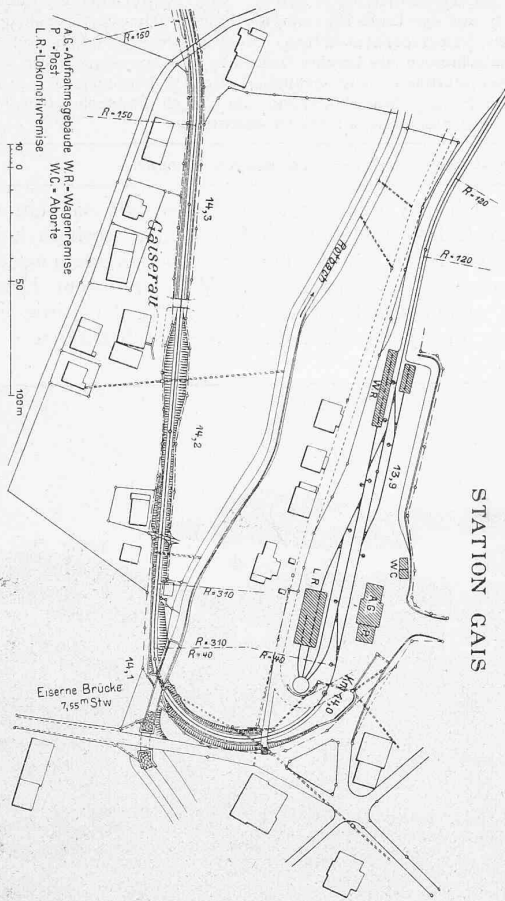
Lageplan der Station Gais. — Massstab 1 : 3000.
